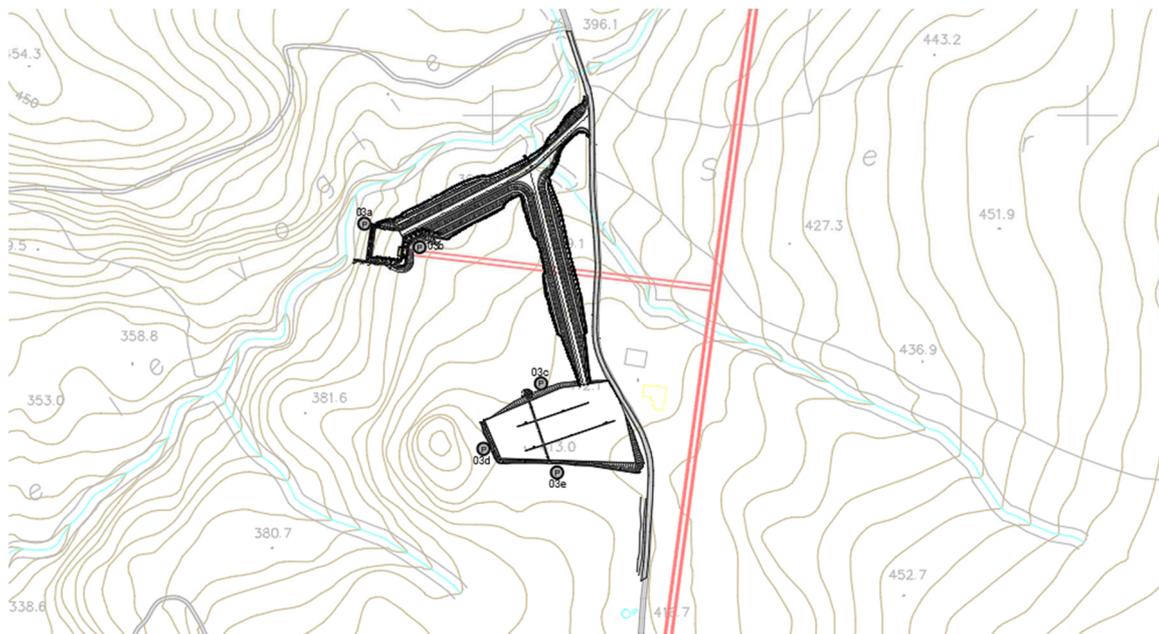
Estratto Planimetria tracciato di Galleria – Galleria di accesso laterale
